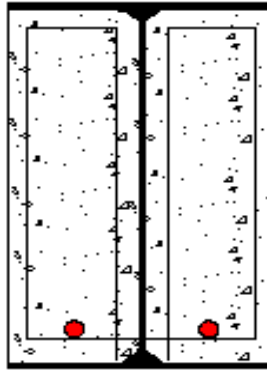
Viga-Mista: Perfil de Aço Preenchido com Concreto Armado
